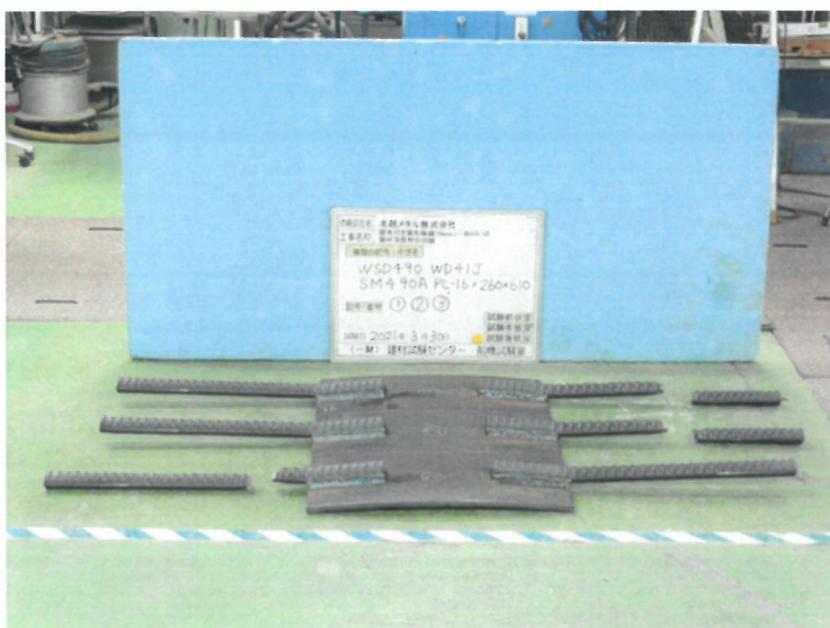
WSD490・WD41J SM490A 溶接引張試験 破断状況
